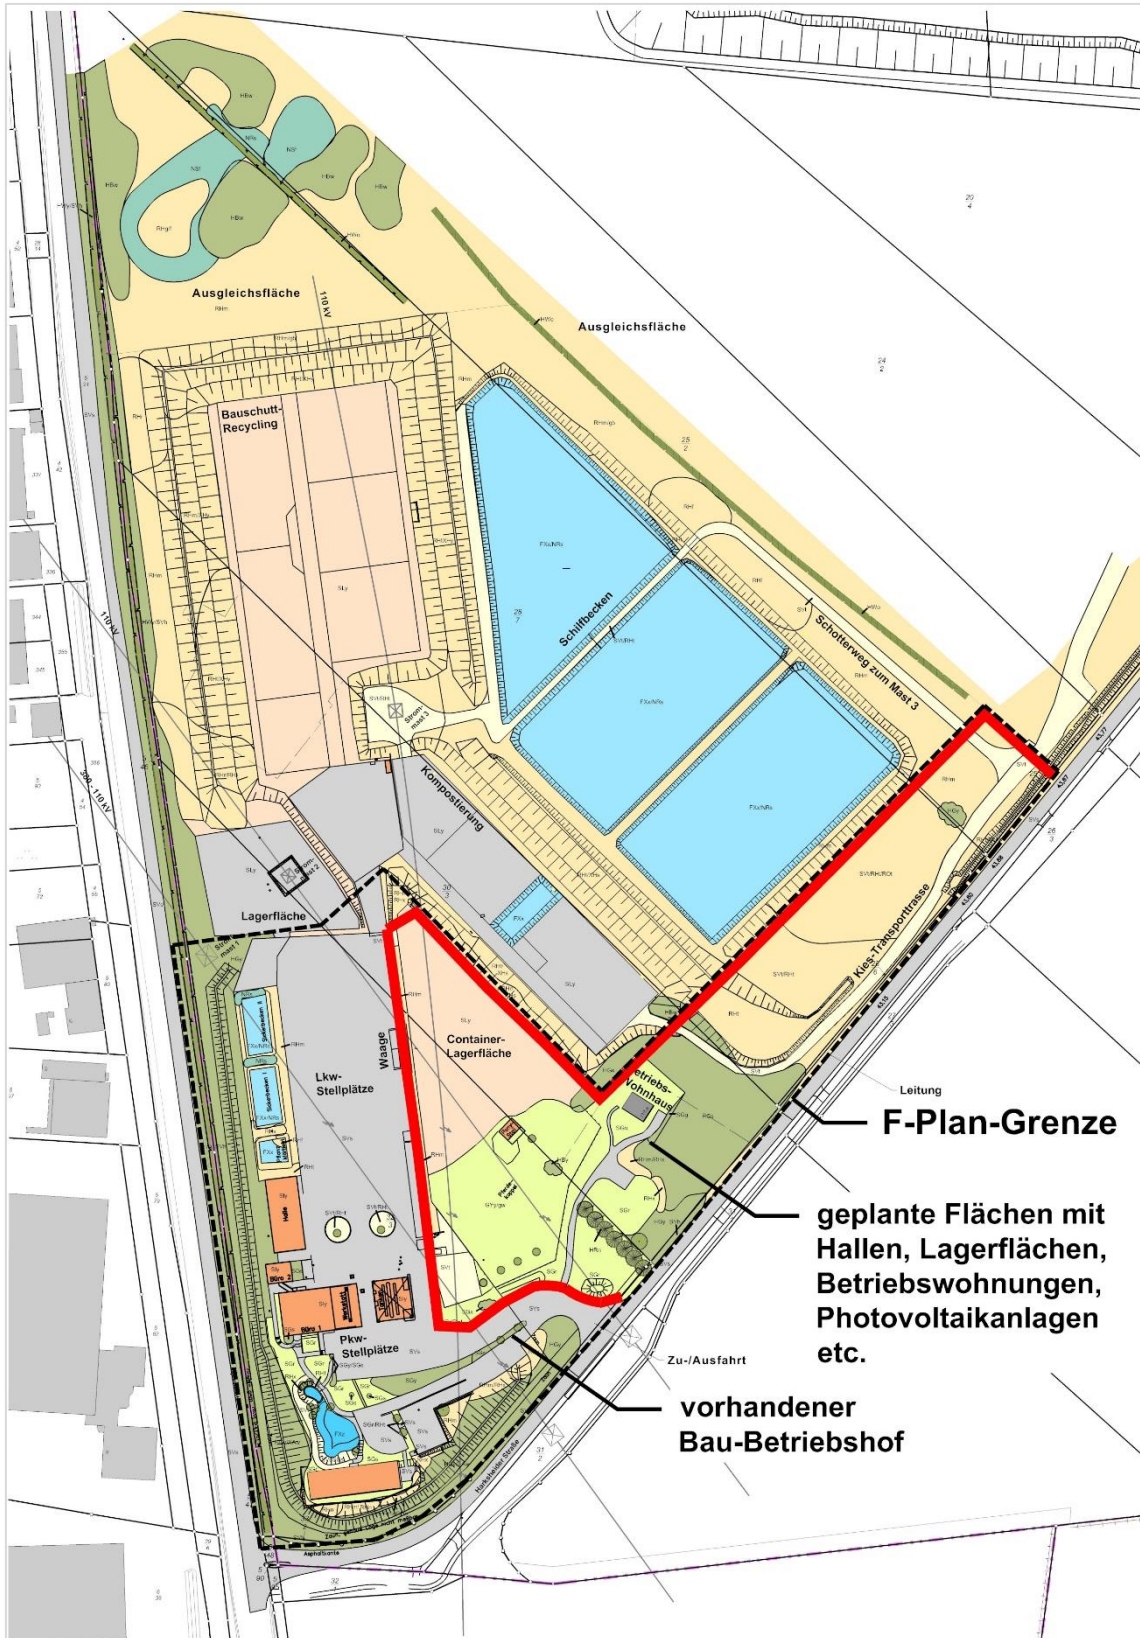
Plangeltungsbereich mit Darstellung Bestand und Planung
